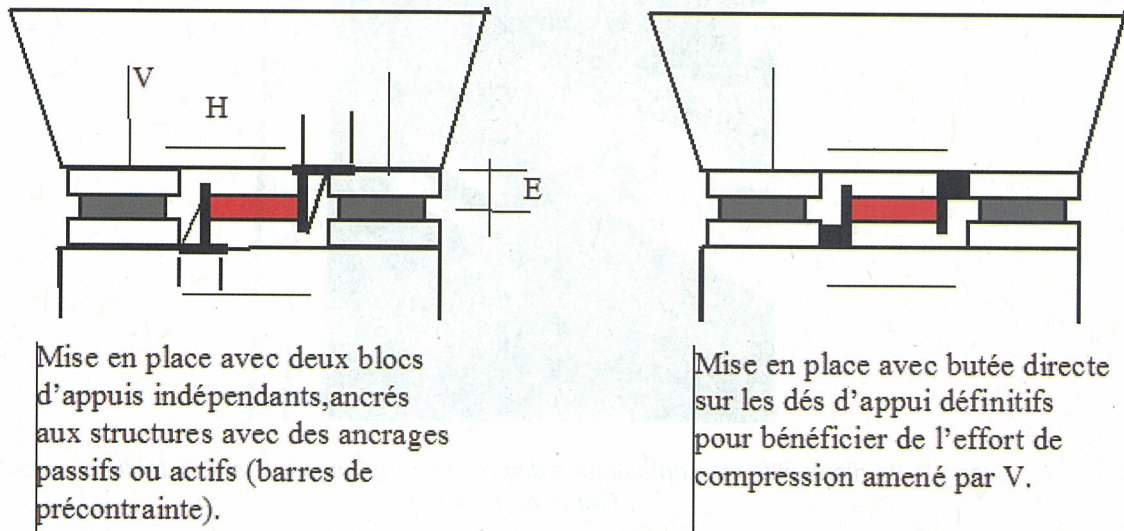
Ouvrage en béton, sens transversal, mise en place entre deux blocs d'appui indépendants ou non
